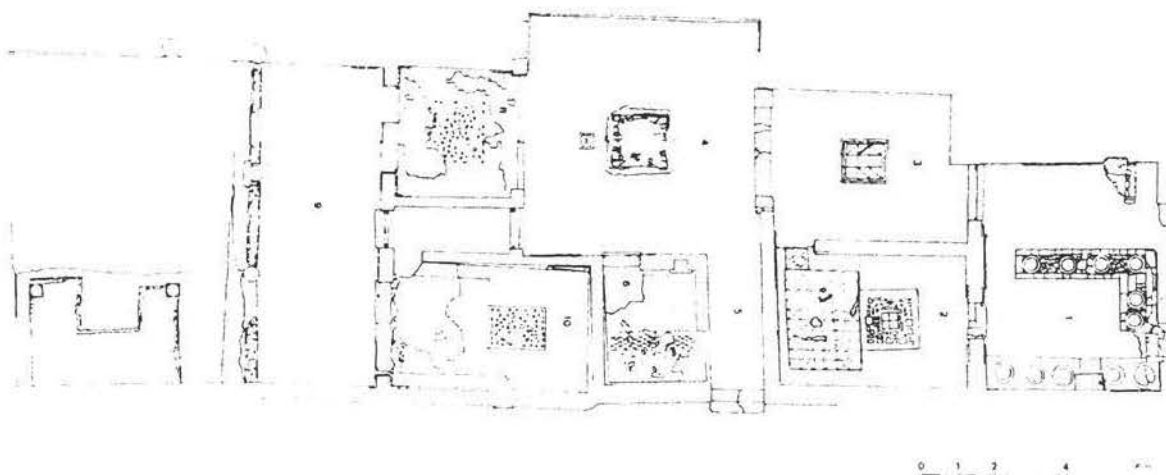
Planimetría general de la Casa/Caupona (1.8.8-9).
